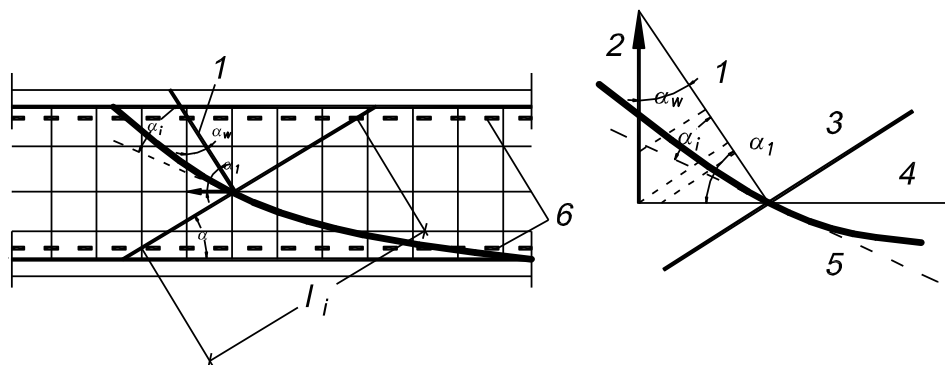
Проекції зусиль у поперечній арматурі на нормаль до нахилого перерізу
